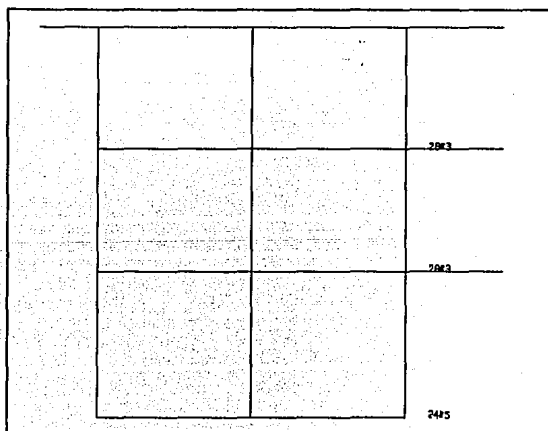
Armado transversal de los muros del eje 2, modelo 2, Q=4
